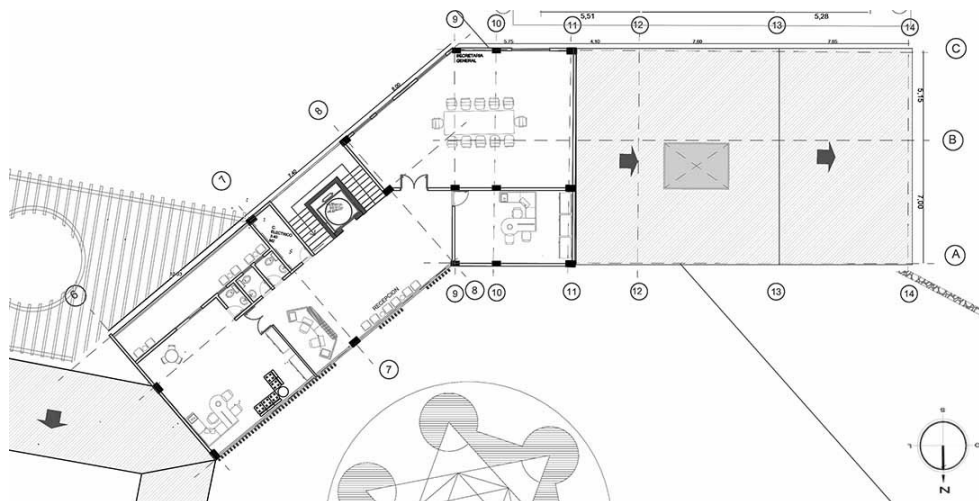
Planta 1er piso bloque administrativo. Fuente: Elaboración propia.
